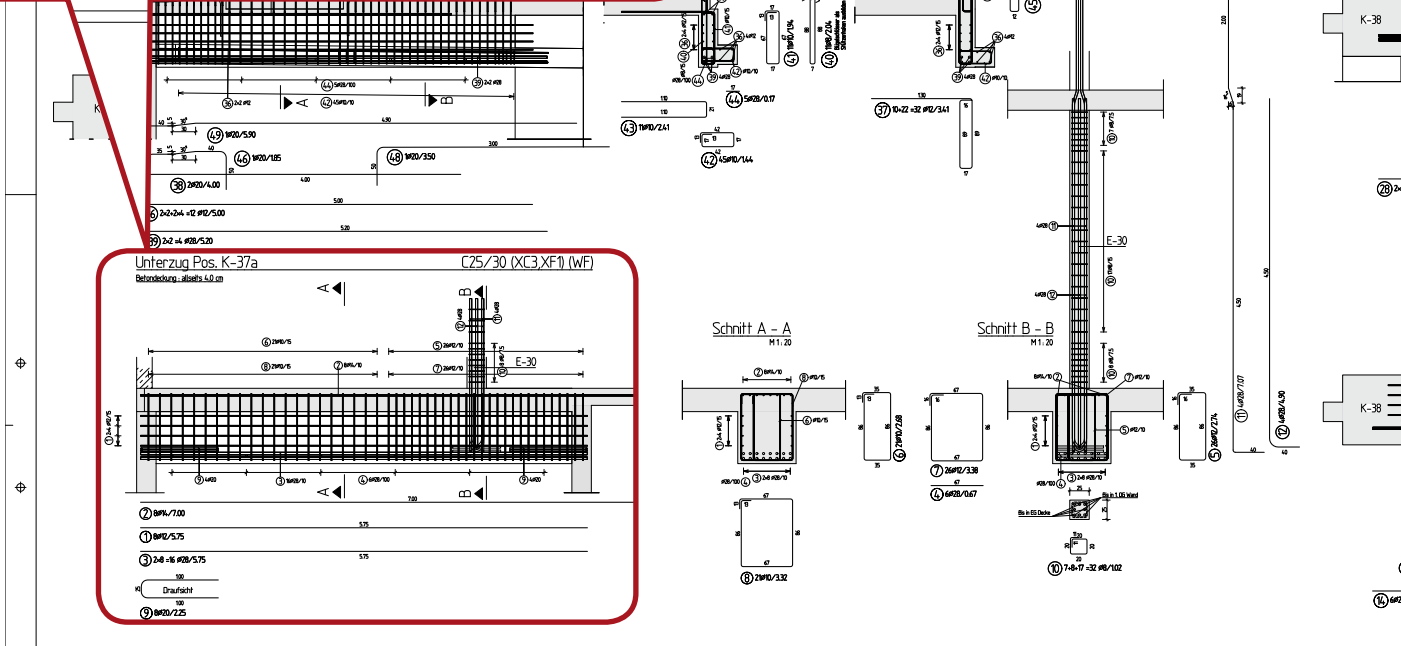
Bauvorhaben Domagkstraße, Unterzüge im Keller-geschoss Haus 3, Prüfung der Bewehrung in unterschiedlichen Sichten mit ViCADo
